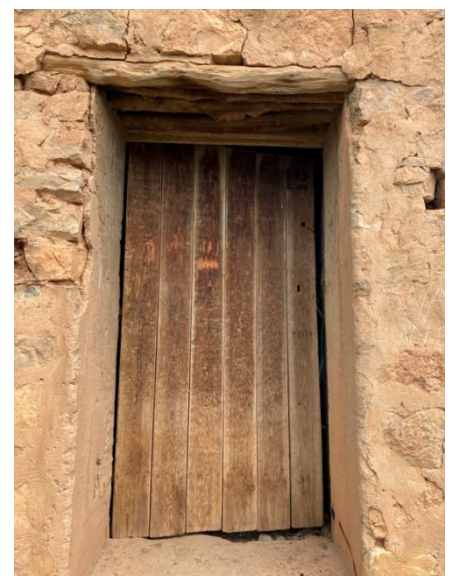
Dispositif constructif d'une porte traditionnelle en bois. [48]
